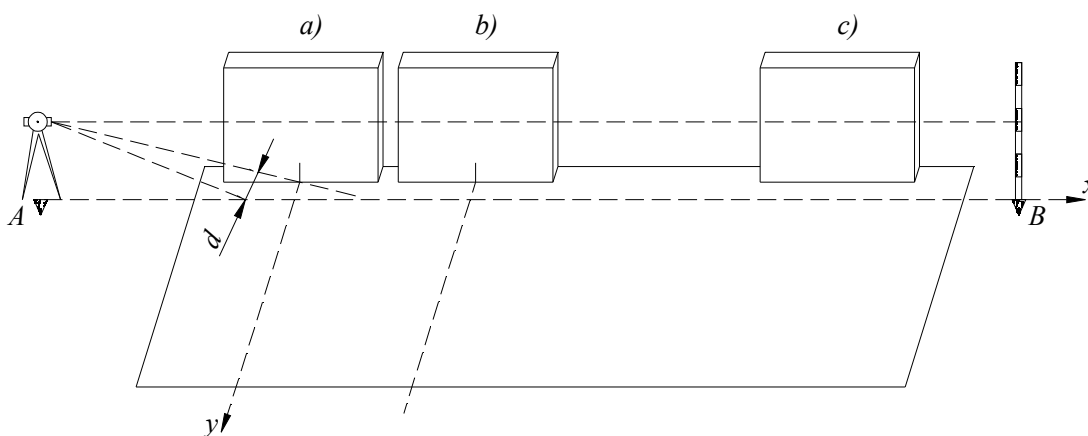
Схема детальной разбивки монтажных осей при монтаже стенных панелей
